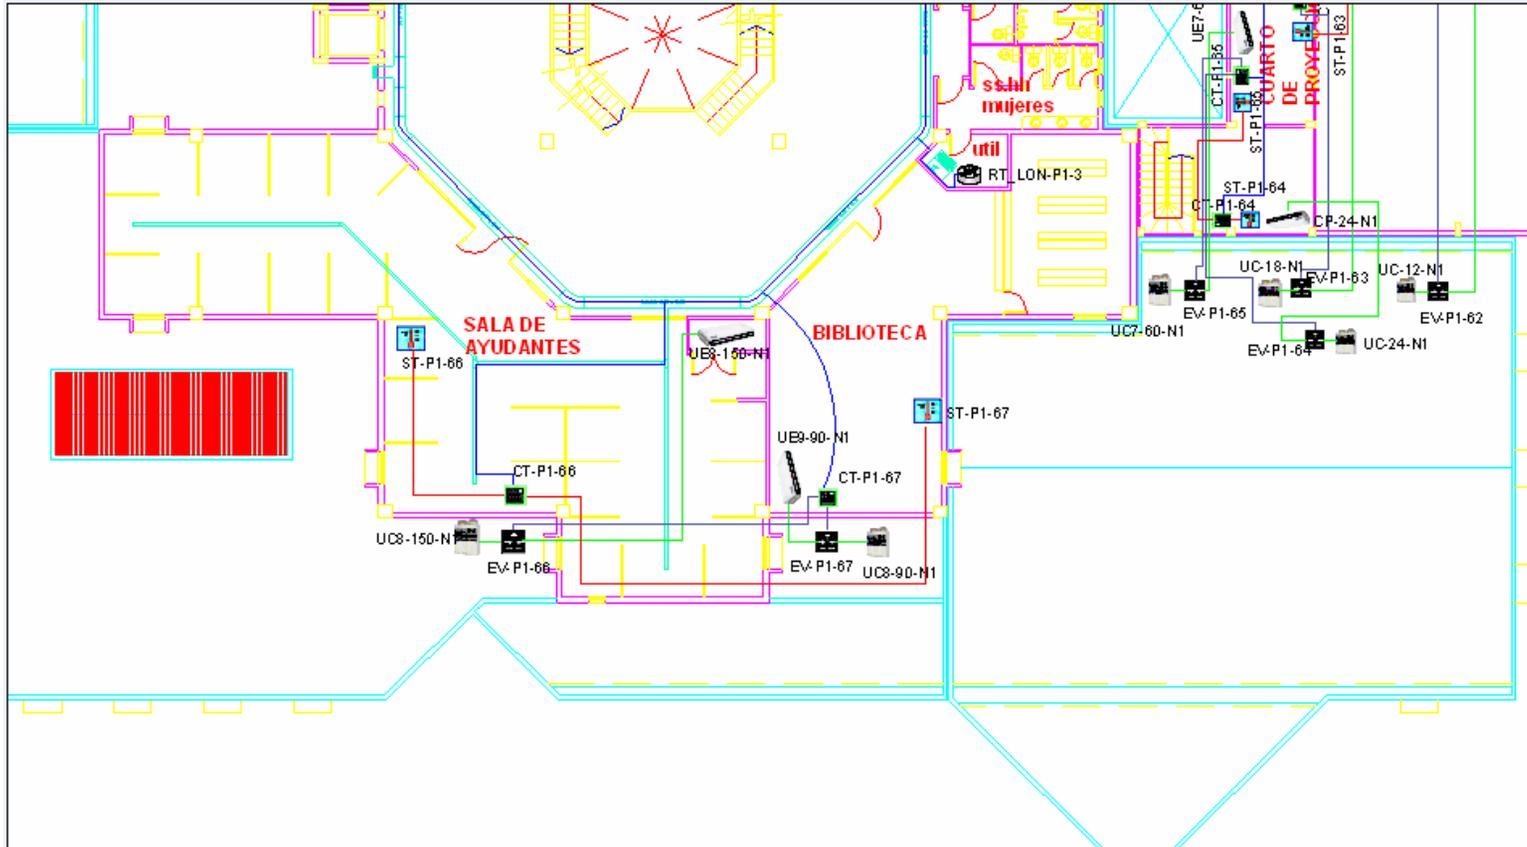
PLANO CLIMATIZACIÓN PRIMER PISO SECCION 2
